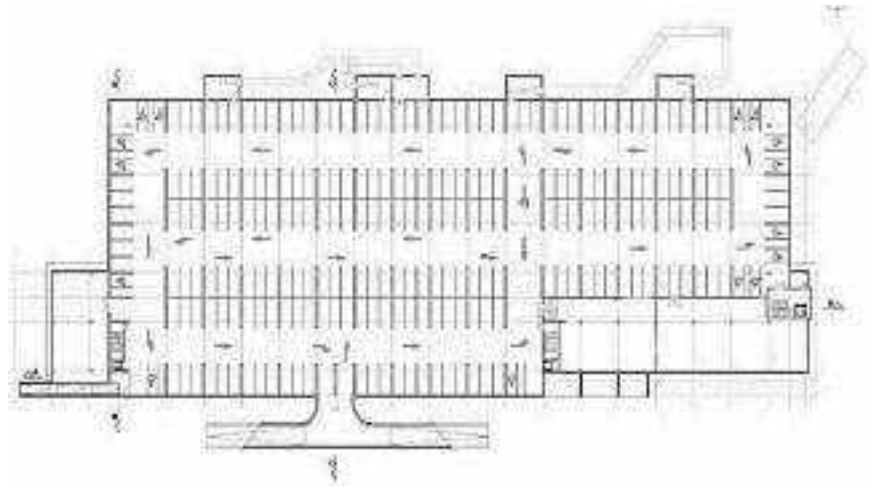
Planta baja del Terminal de Buses Osijek. Elaboración propia
